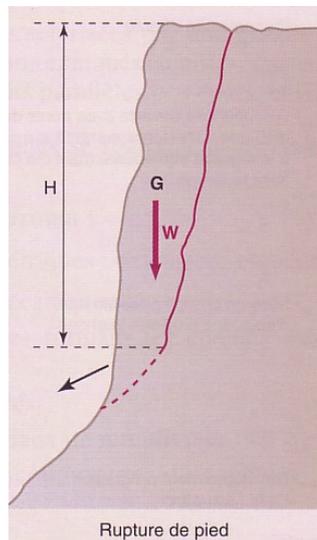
schéma de principe d'une rupture de pied (LCPC)
